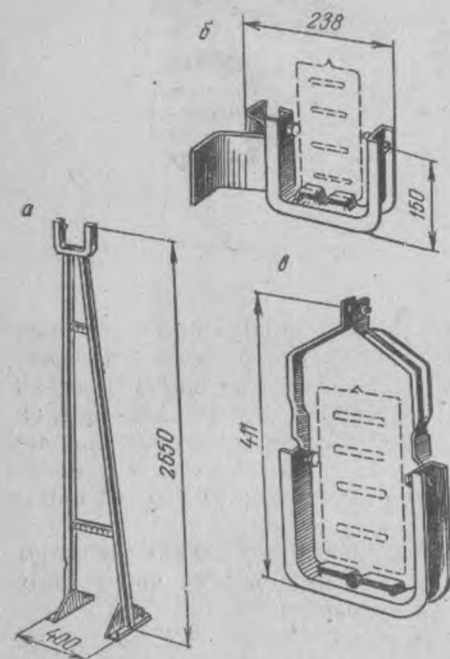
Опорные конструкции для распределительных шинопроводов: а — стойка, б — кронштейн, в — тросовый подвес
